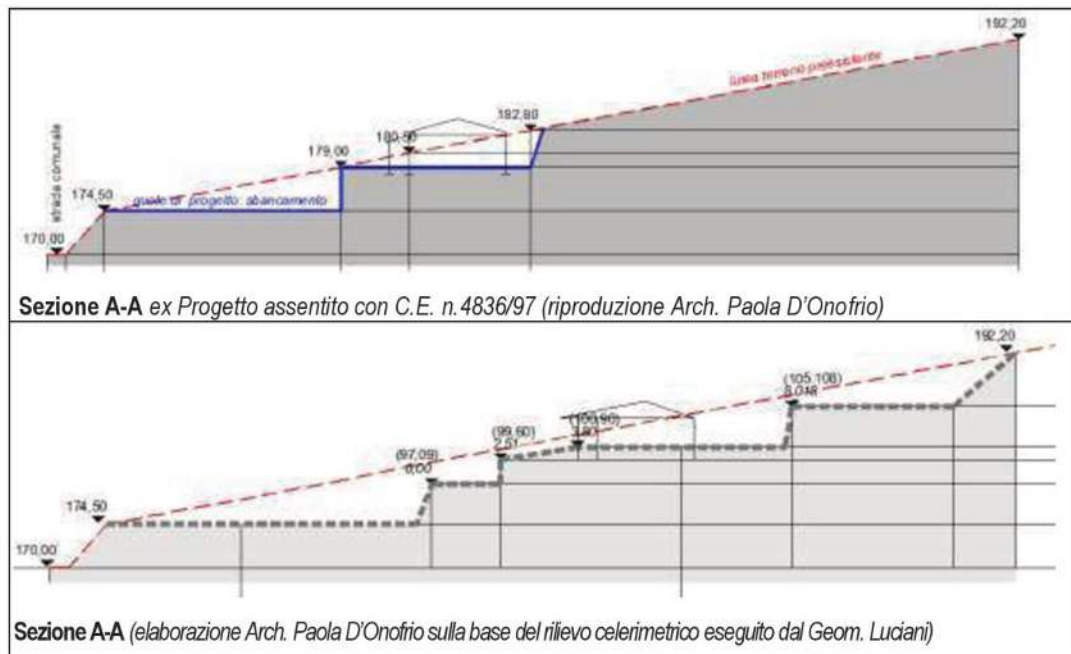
Andamento del terreno: confronto tra la sezione A-A (ex progetto assentito) e una sezione schematica dello stato di fatto
